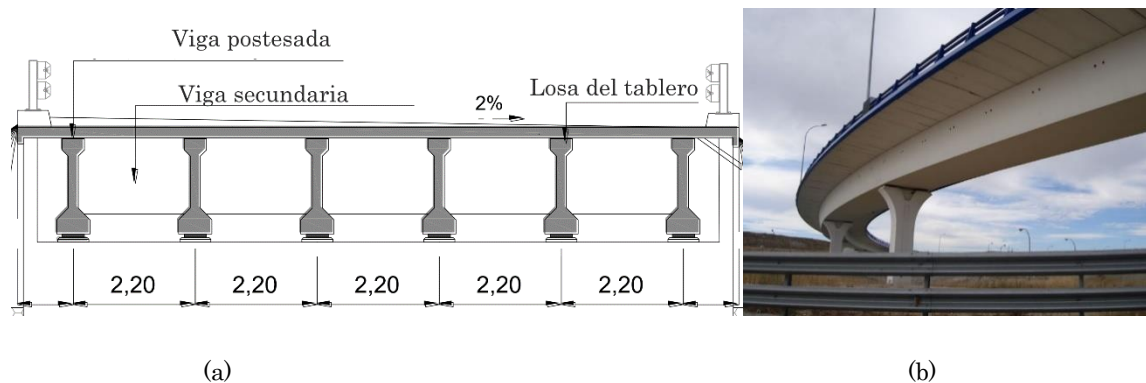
a): Puente de vigas “I”. Fuente: Catedra hormigón armado UNNE. b) Puente curvo solicitado a torsión (Fuente: Pacadar).
